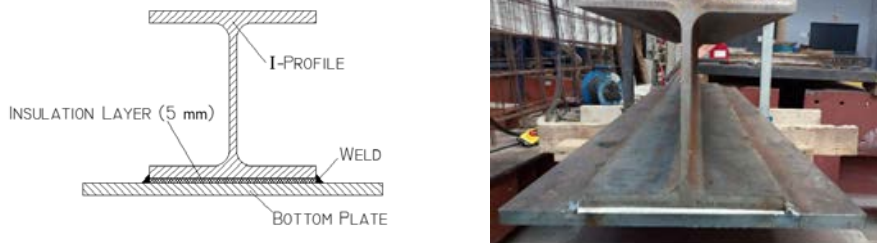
Viga mixta slim-floor con protección inherente al fuego.
